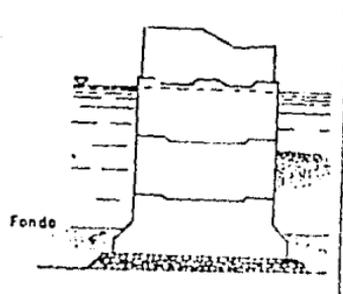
Bloques de concreto simple precolados o colados "in situ".
